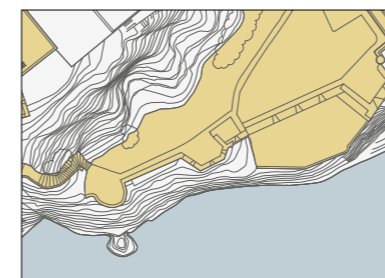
Detalle del plano actual. (MJB 2017).
